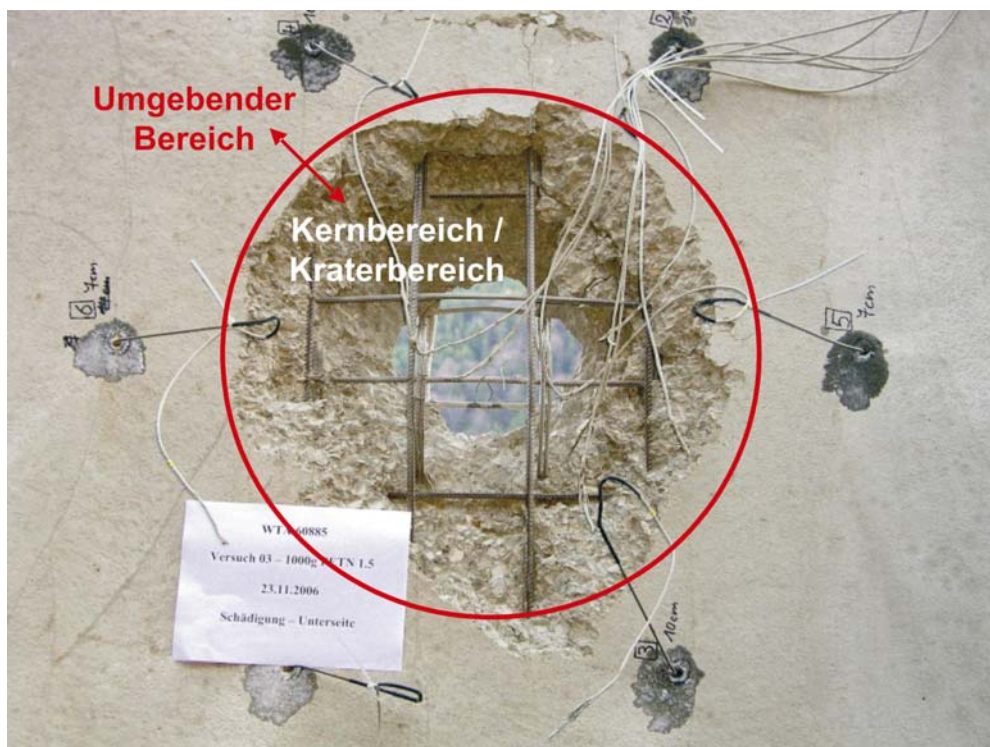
Schädigungsbereich einer Stahlbetonplatte nach Kontaktdetonation.
